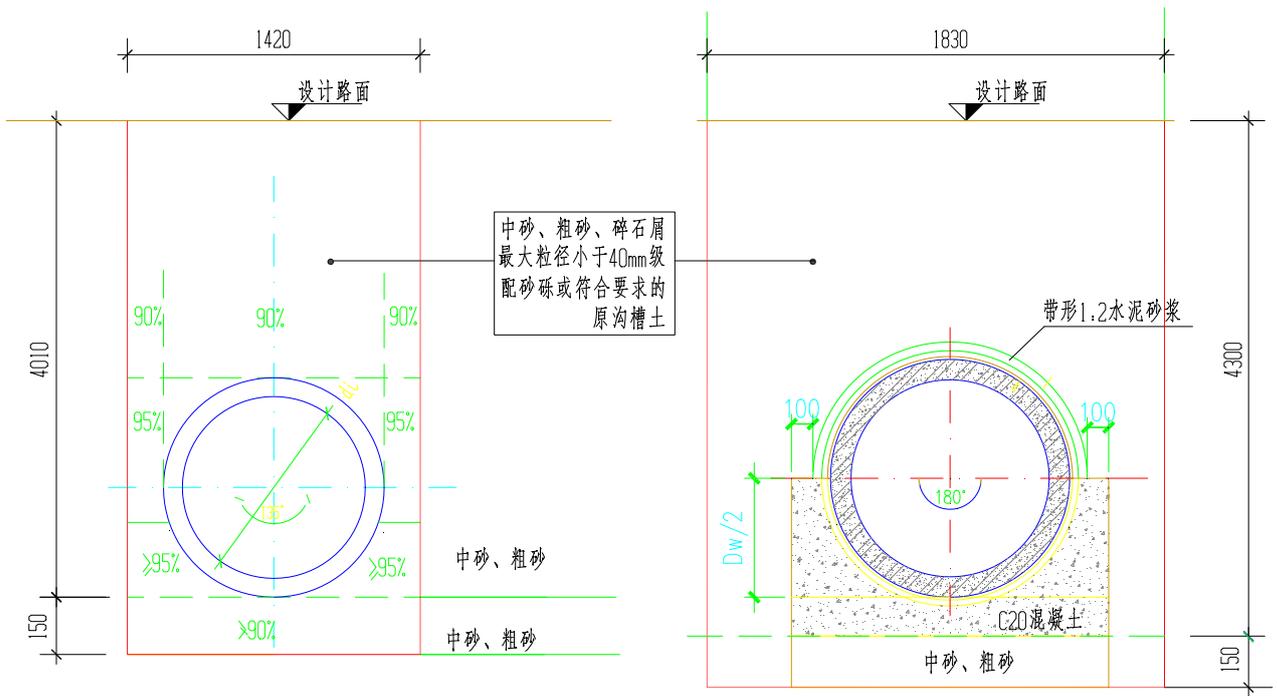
HDPE 缠绕结构壁管沟槽断面图钢筋混凝土管沟槽断面
